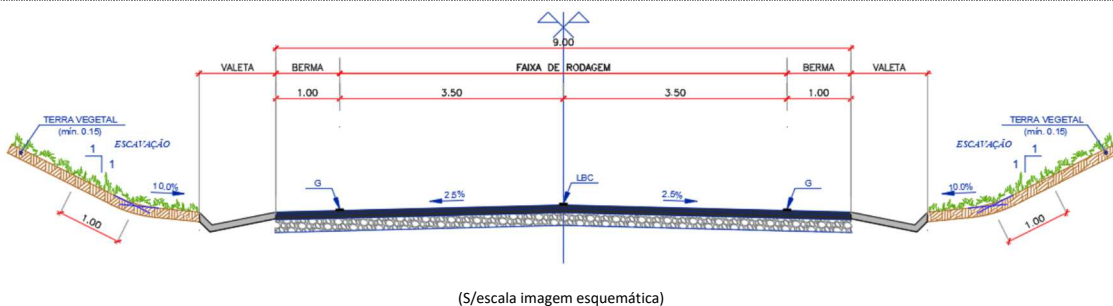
Perfil Transversal Tipo – Restante traçado
